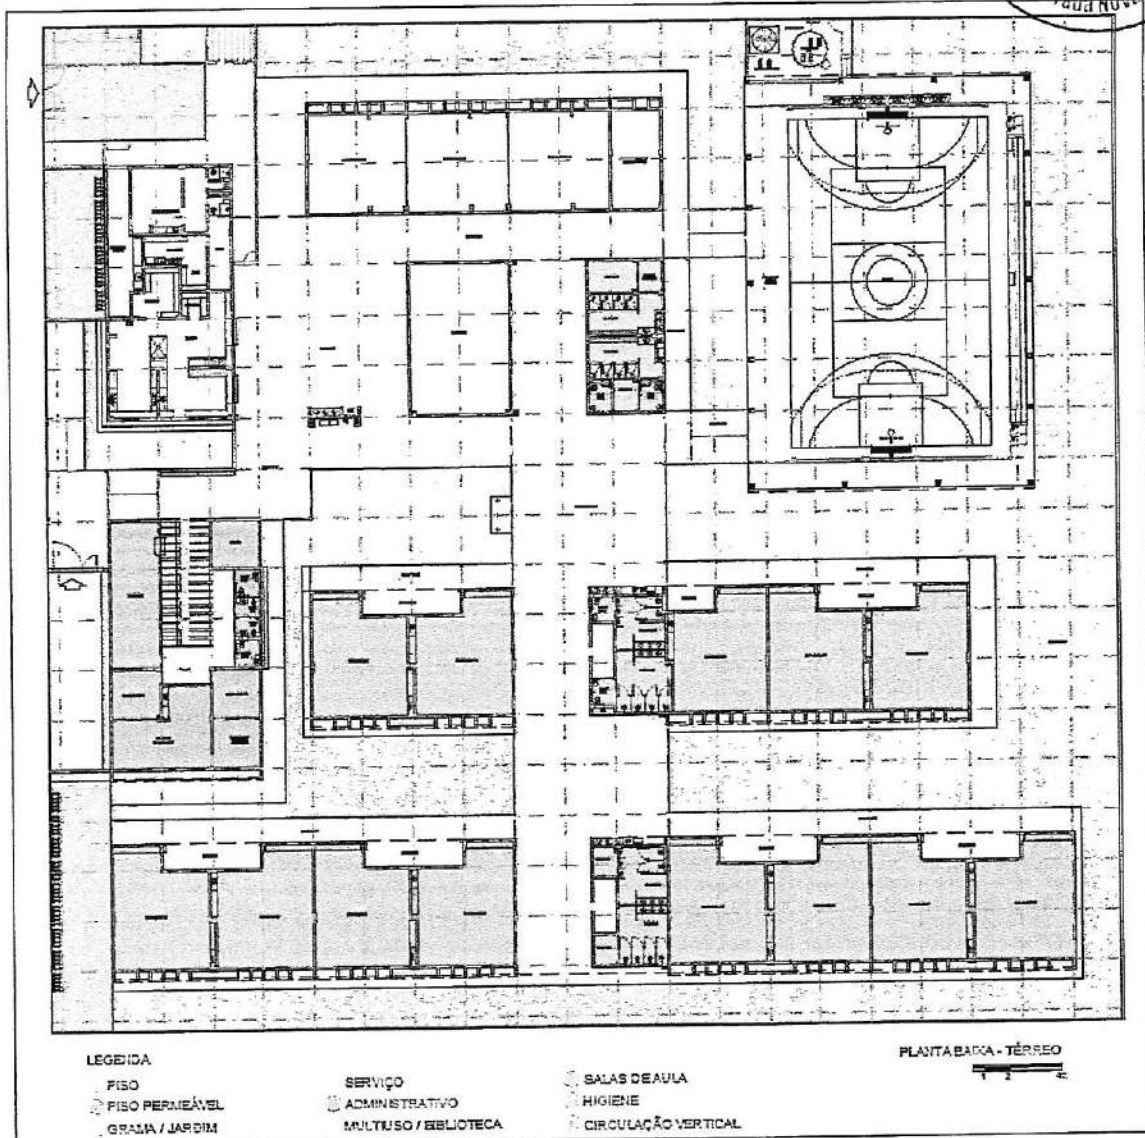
planta baixa de implantação dos blocos – Escola 13 Salas - Térreo
